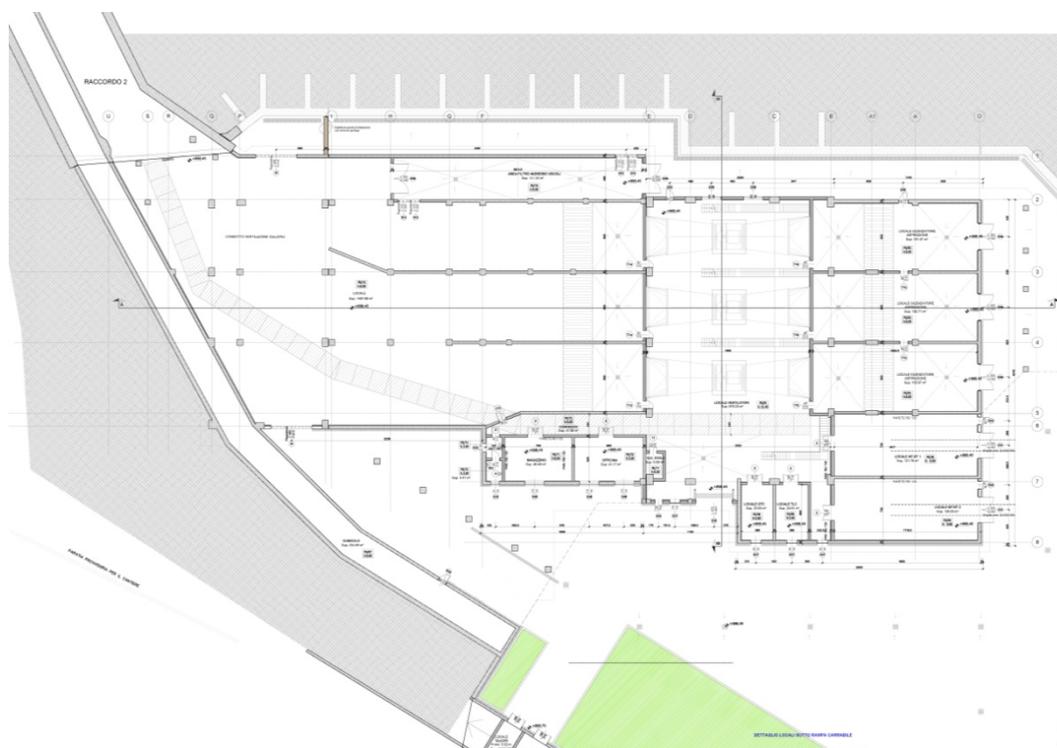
Modifiche alla pianta delle centrali di progetto definitivo approvato
